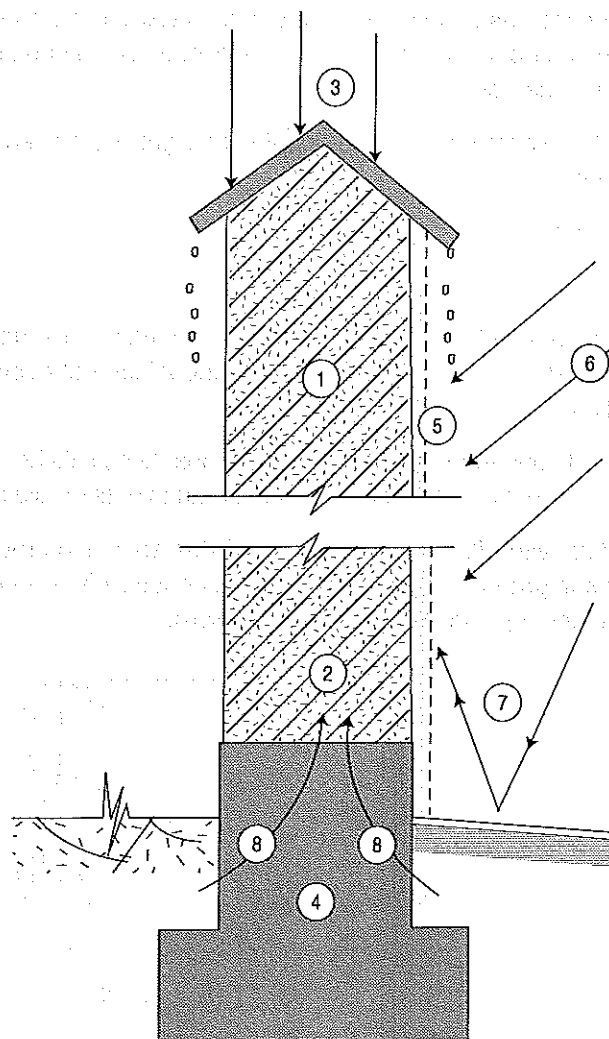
Réfection d'un enduit sur mur en pisé.
